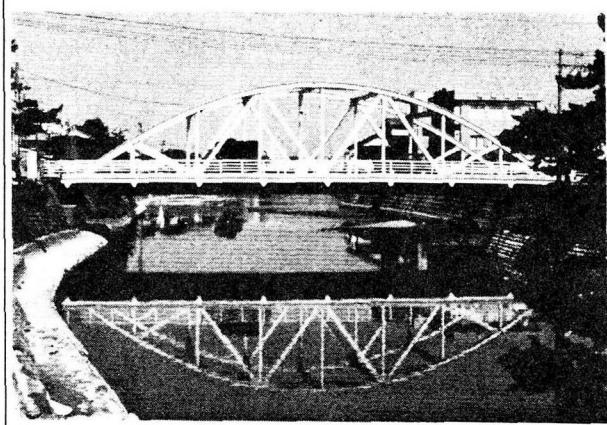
補強後(補強ローゼ桁:ボーストリングタイプ)
